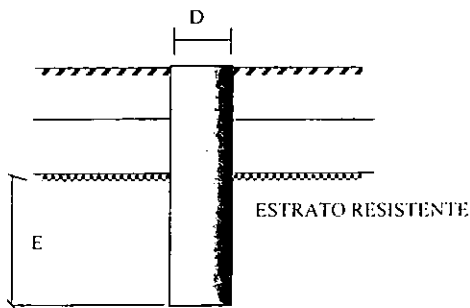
EMPOTRAMIENTO DE PILAS Y PILOTES
